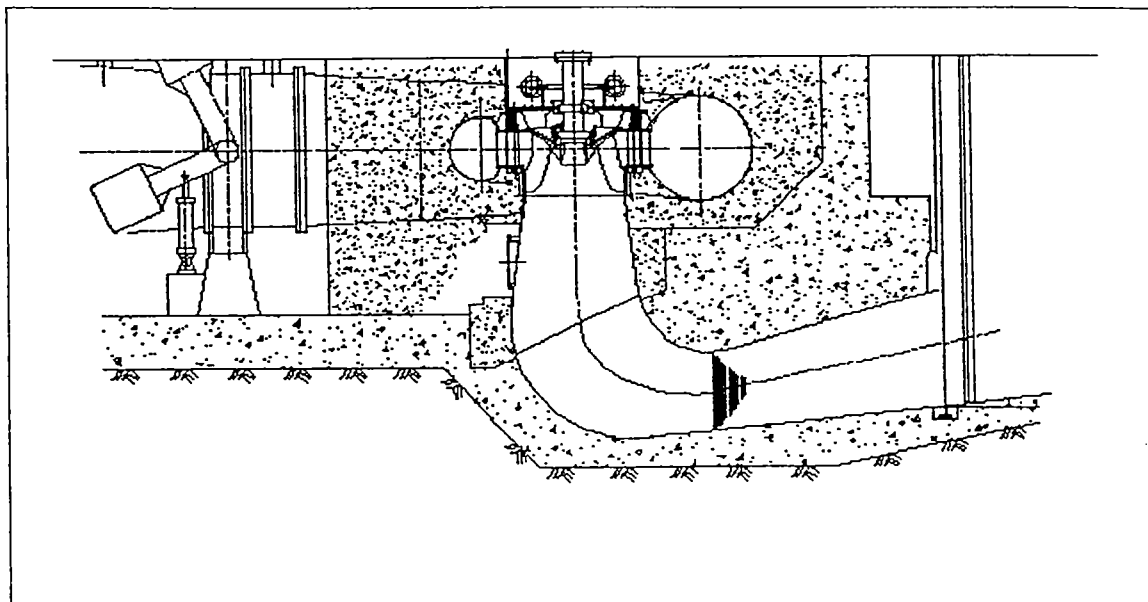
Desenho em corte de uma turbina hidráulica
